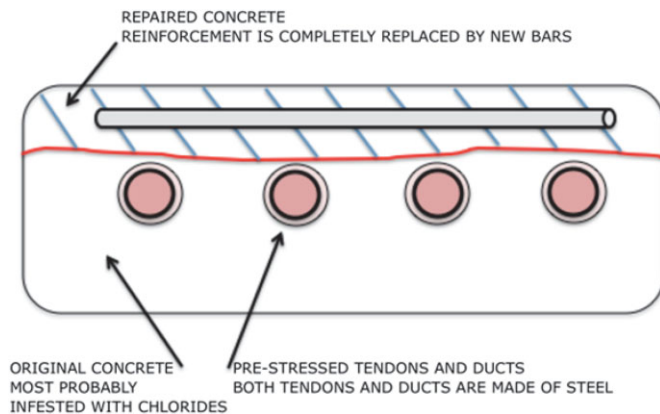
Durchgeführte Instandsetzung an Brückendecke knapp unterhalb der Asphaltenschicht
